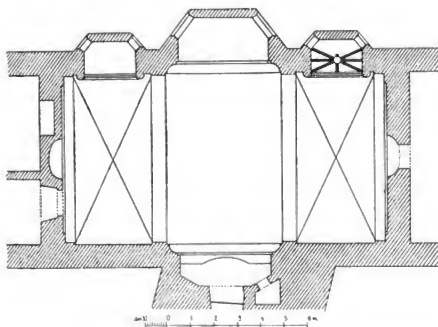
Zbiroh. Grundriss der Kapelle.
